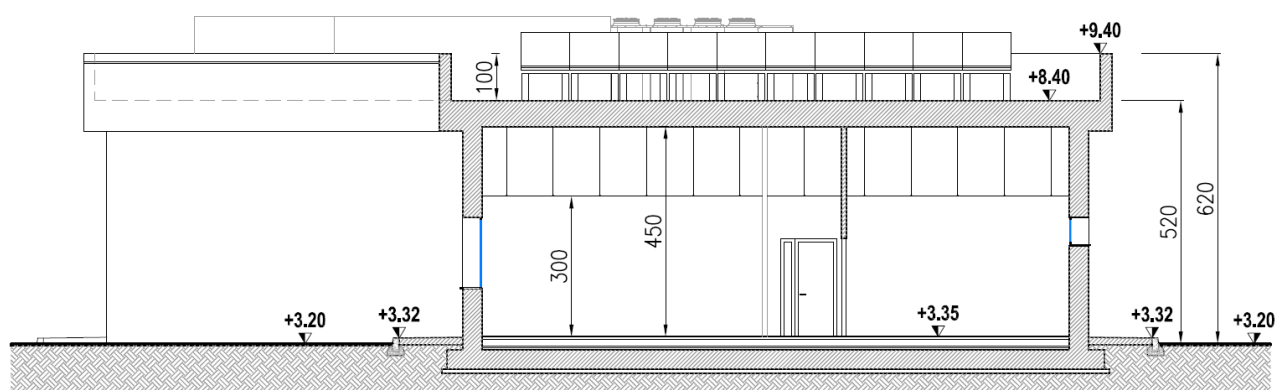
Vista in sezione della palazzina uffici e laboratorio della Piattaforma bio-recupero Eni Rewind (stralcio elaborato 090026-ENG-D-DG-3032 - PALAZZINA UFFICI/CTB - PIANTE FONDAZIONI, PIANTE PIANO TERRA, PIANTE COPERTURE, SEZIONI E PROSPETTI)
